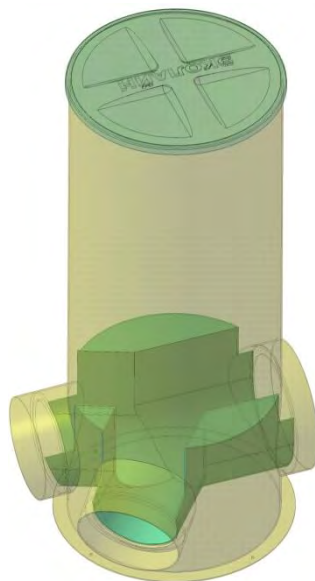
Колодец с сороудерживающей корзиной и шиберным затвором
